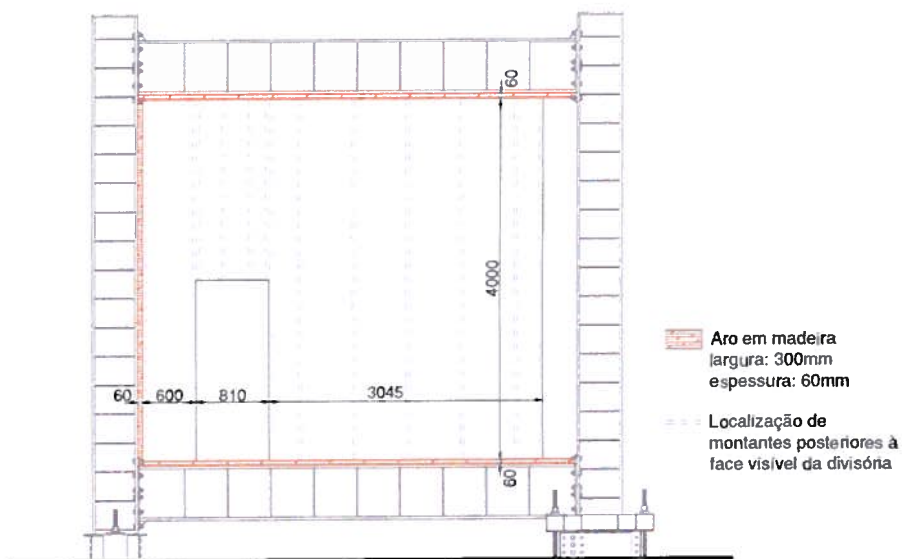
Vista esquemática do provete aplicado no pórtico metálico (antes da aplicação da porta).
